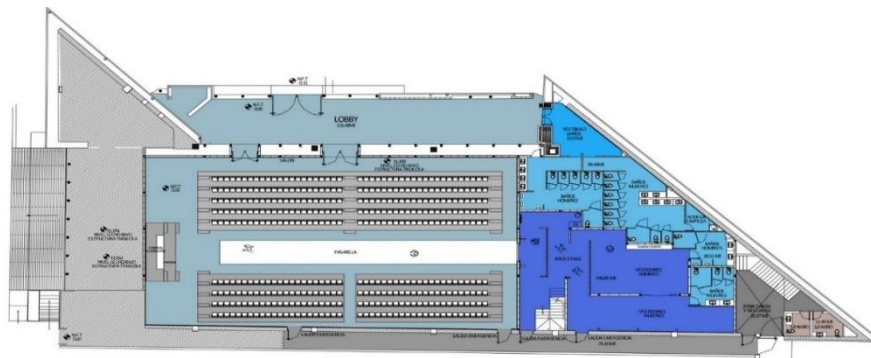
plano arquitectónico, primer espacio para pasarelas en México, Guadalajara (Moreno, 2014)
